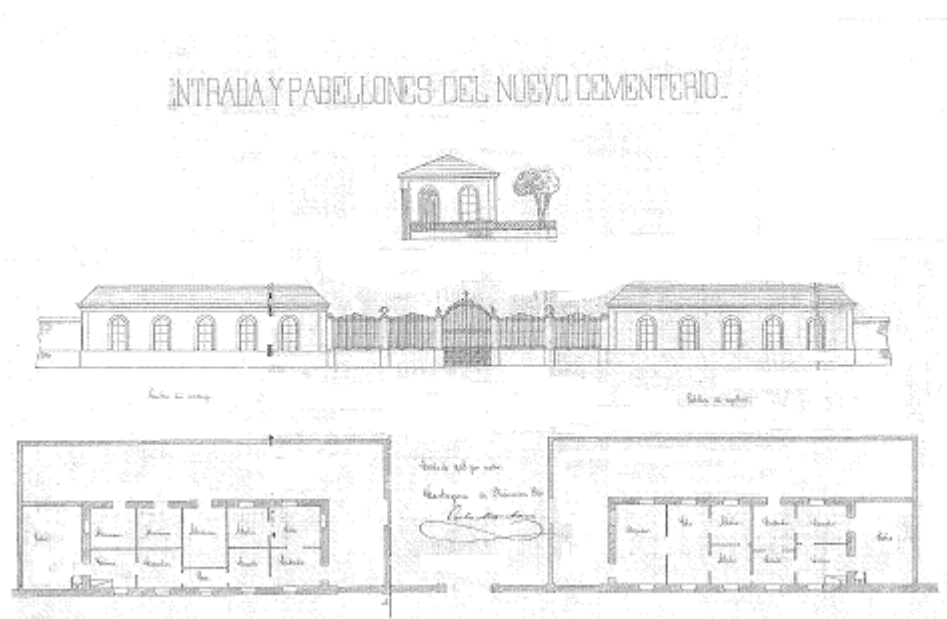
Plano de la entrada y pabellones de Carlos Mancha
